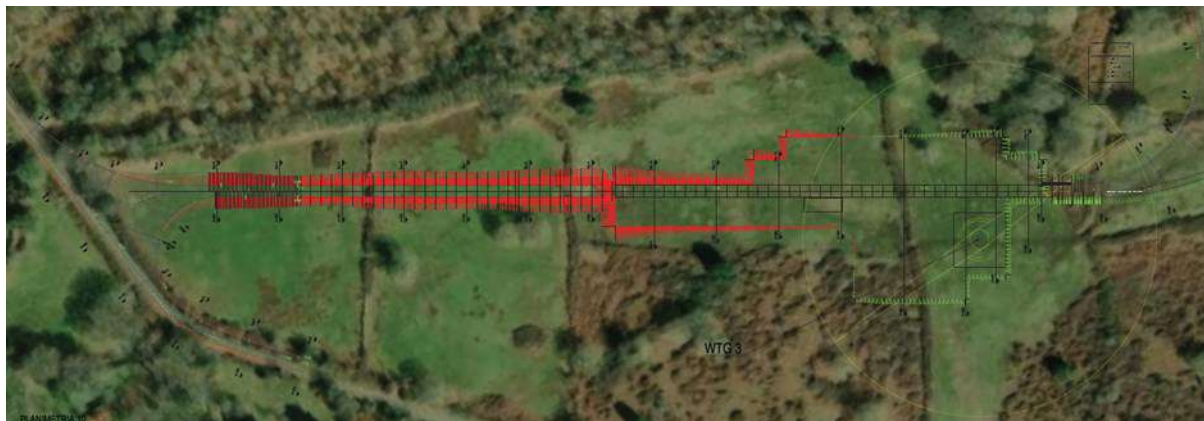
Tracciato planimetrico viabilità di nuova realizzazione.
